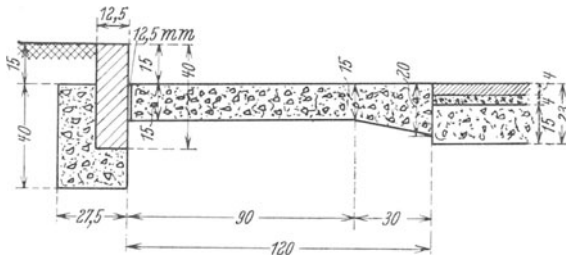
Randstreifen aus Beton bei Asphaltstraßen in St. Louis (V. St. A.).
